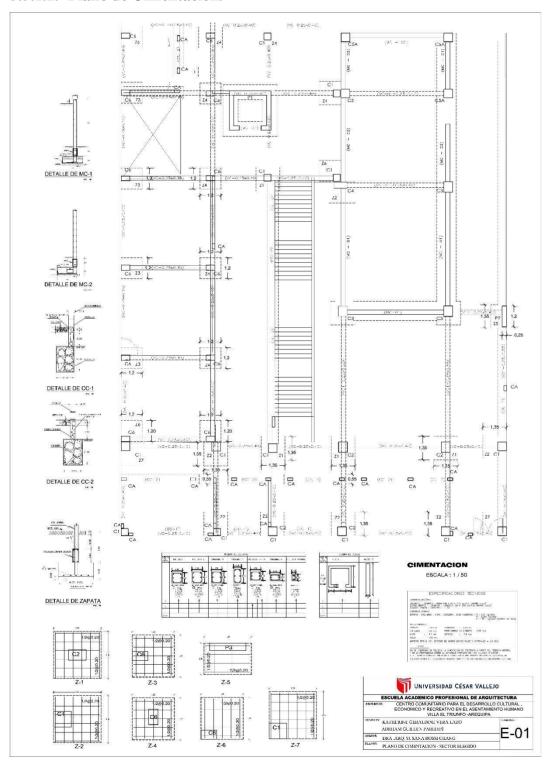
Plano de cimentación sector elegido - Elaboración propia
